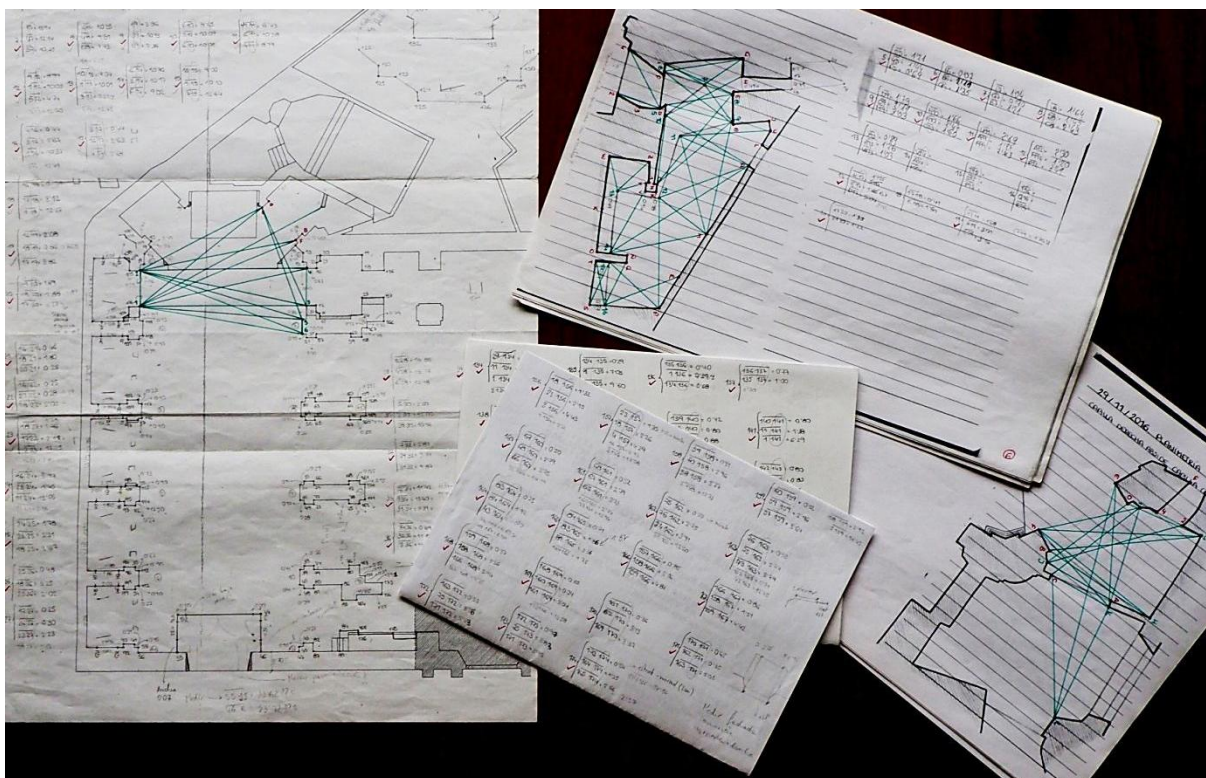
Proyección del levantamiento planimétrico y mediciones en planta.
